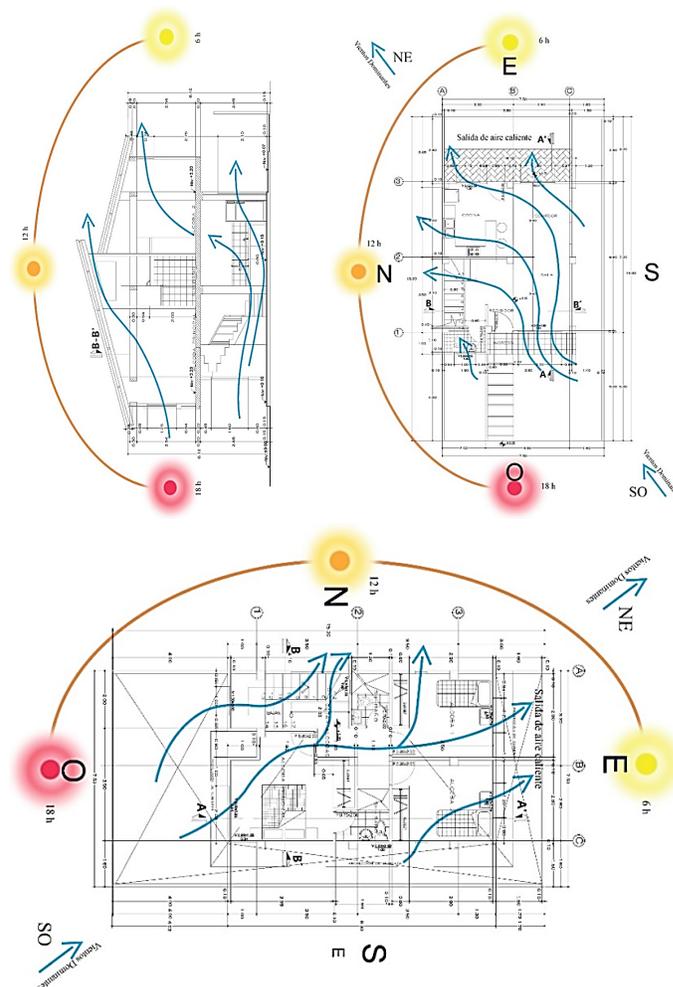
Planta baja y planta alta de prototipo de vivienda.
